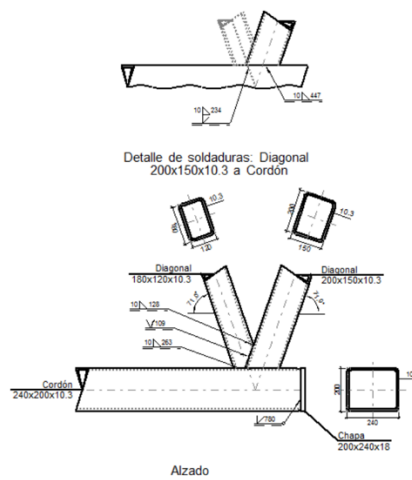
Detalle unión cordón inferior con diagonal del punto más bajo.
